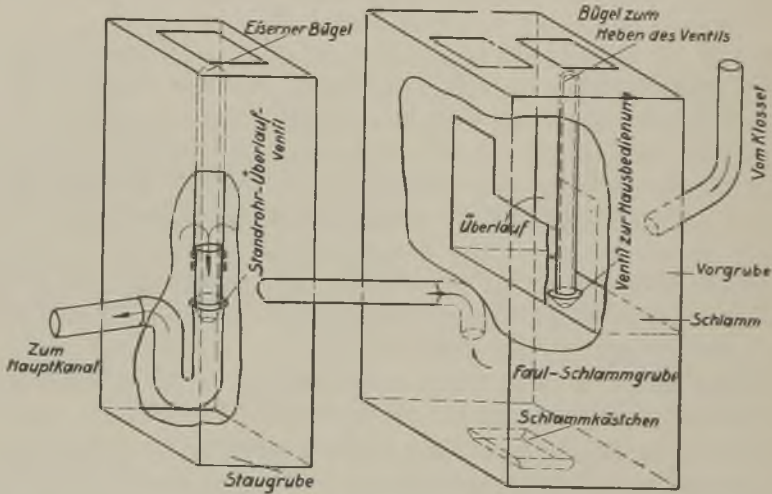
Einfache Kläranlage für Spülaborte. Schematische Darstellung — ältere Bauart. Ausführung in Beton.
